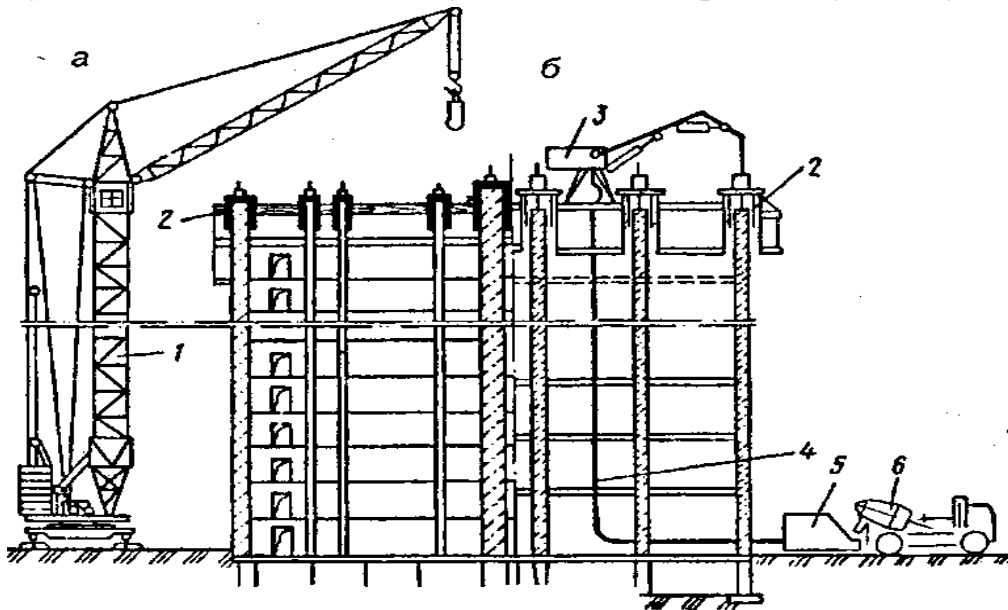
Технологічна схема зведення будівлі в ковзній опалубці з подачею бетонної суміші баштовим краном (а) і бетононасосним транспортом (б):
